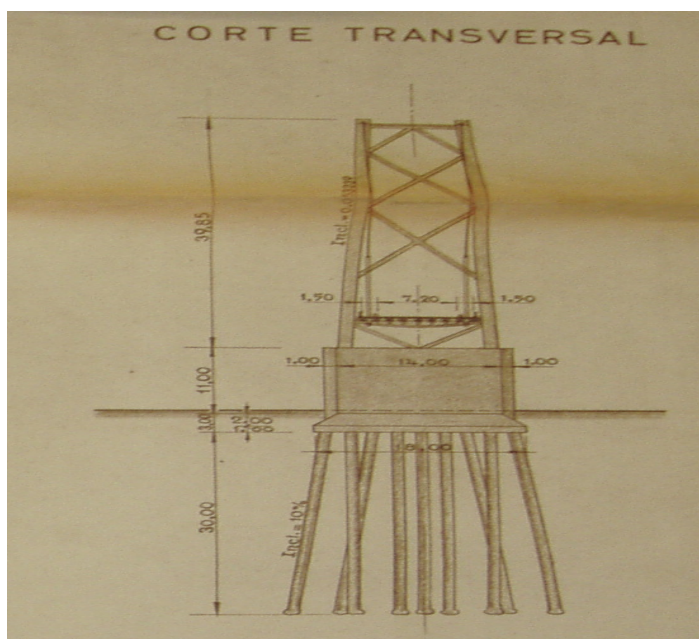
Corte transversal da fundação, Cardoso, Edgar 1963.
